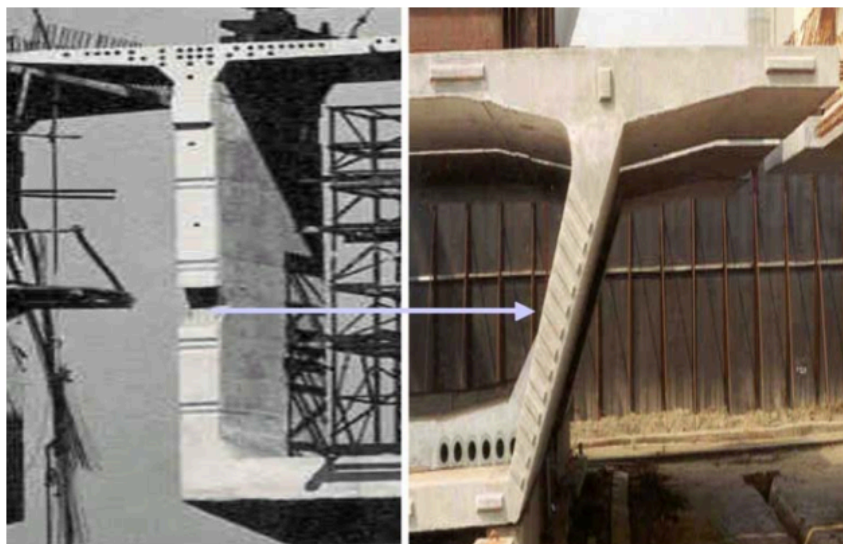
Comparação entre o sistema de primeira geração e de segunda geração
